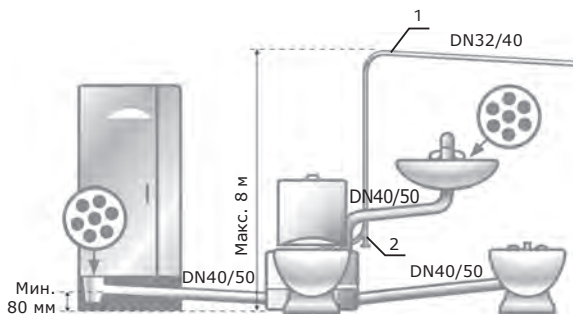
Рекомендуемая схема монтажа напорного трубопровода
